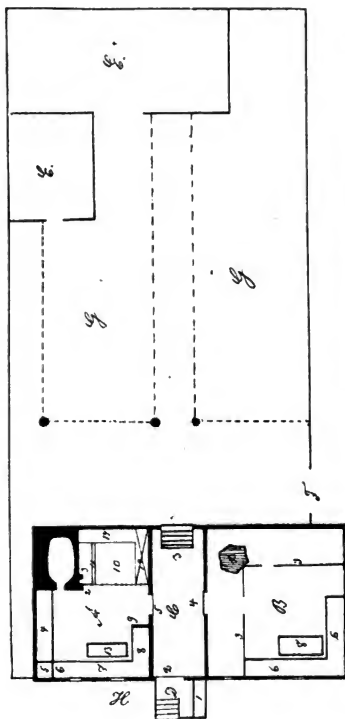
Grundriss einer Kud (*A*) und einer rollende Kud (*B*), Drákino. Tambov.
